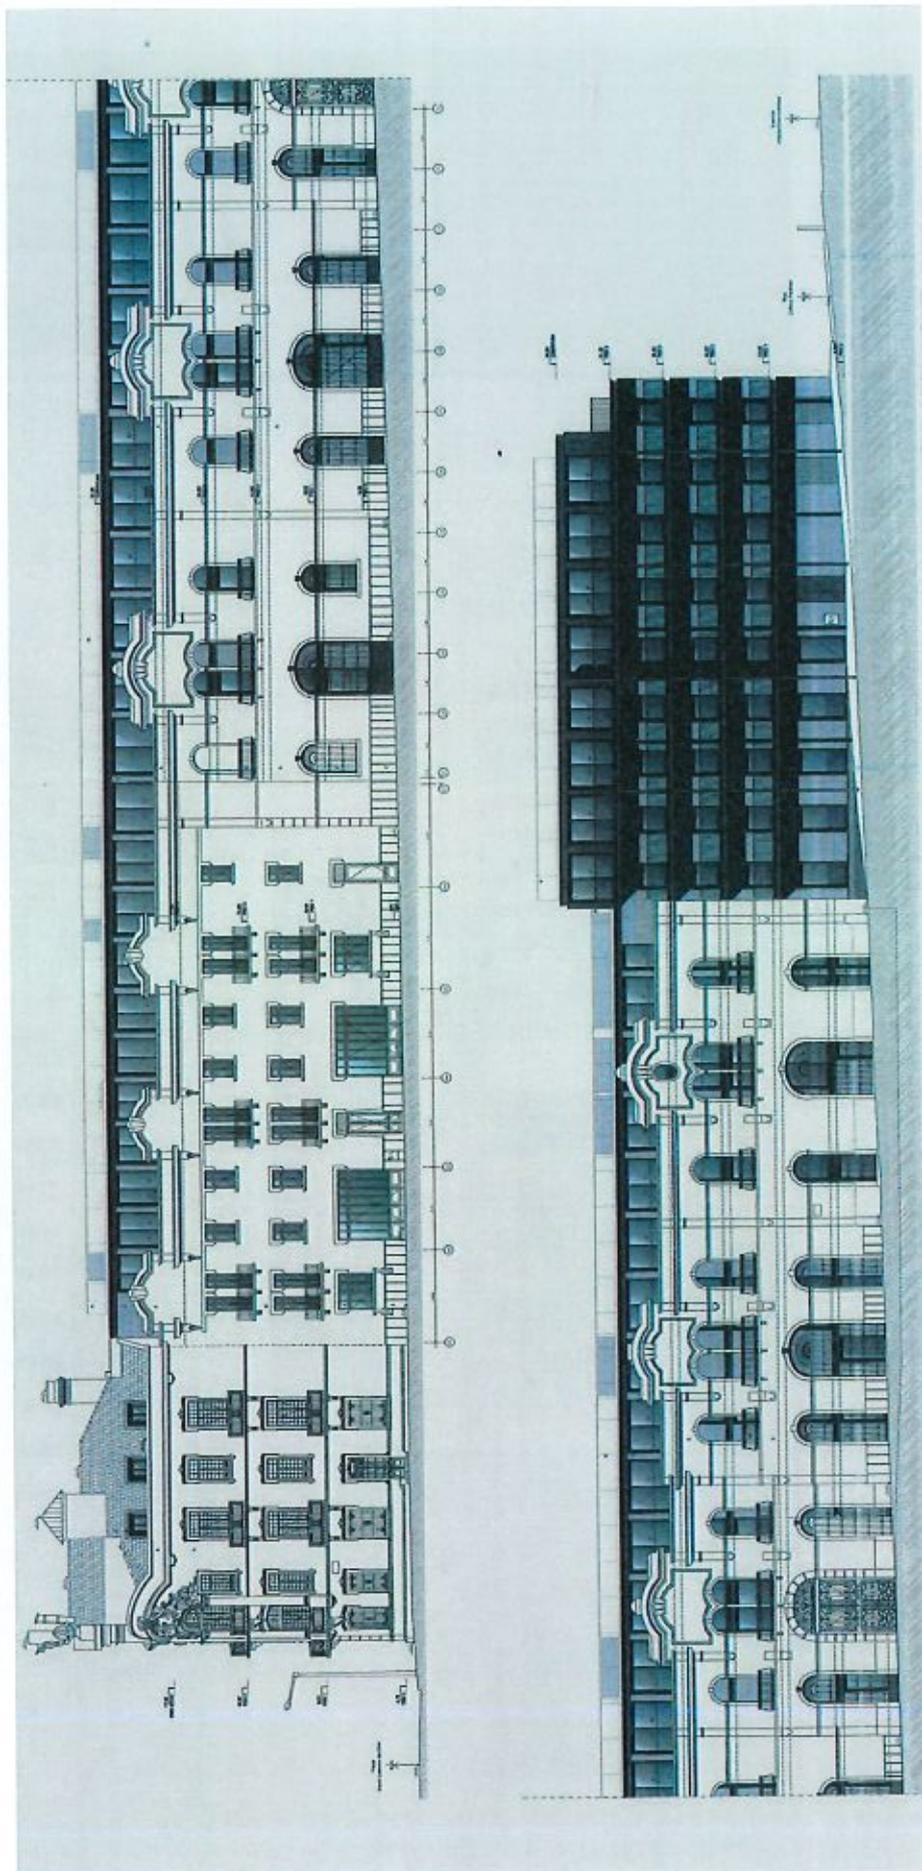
Excerto, Desenho da Proposta/Projeto de Licenciamento, fevereiro de 2021. Cortes e Alçados, Alçado nascente / Rua Fernando Palha 2.01.
